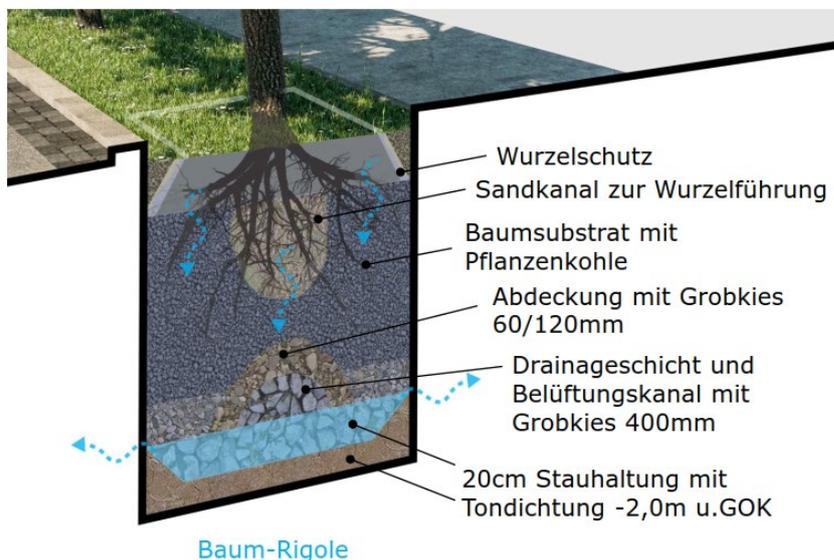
Baumrigole mit Einstaubewässerung (RSD)
